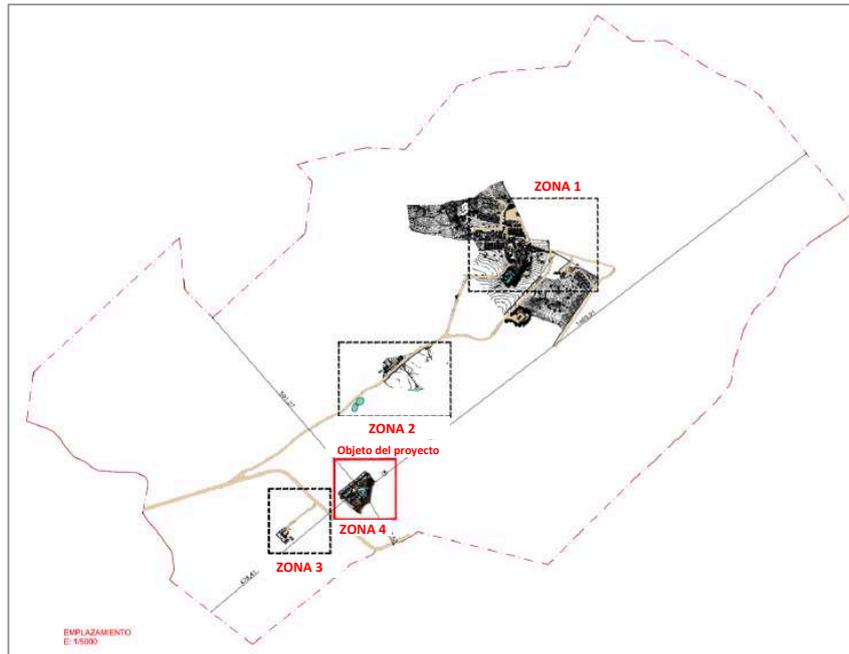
Plano de situación de las edificaciones existentes y la nueva construcción prevista (fuente: proyecto)
